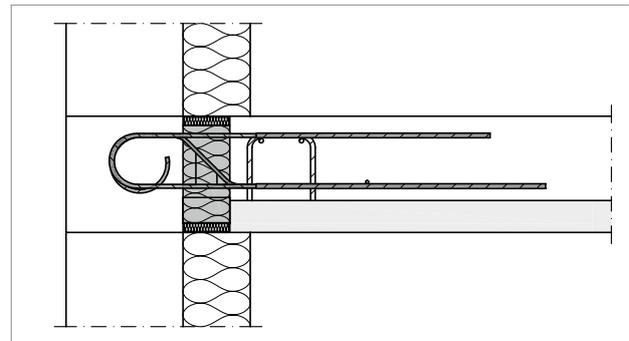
Schöck Rutherma® T type DF : liaison pour façade en béton armé et plancher constitué de prédalles
